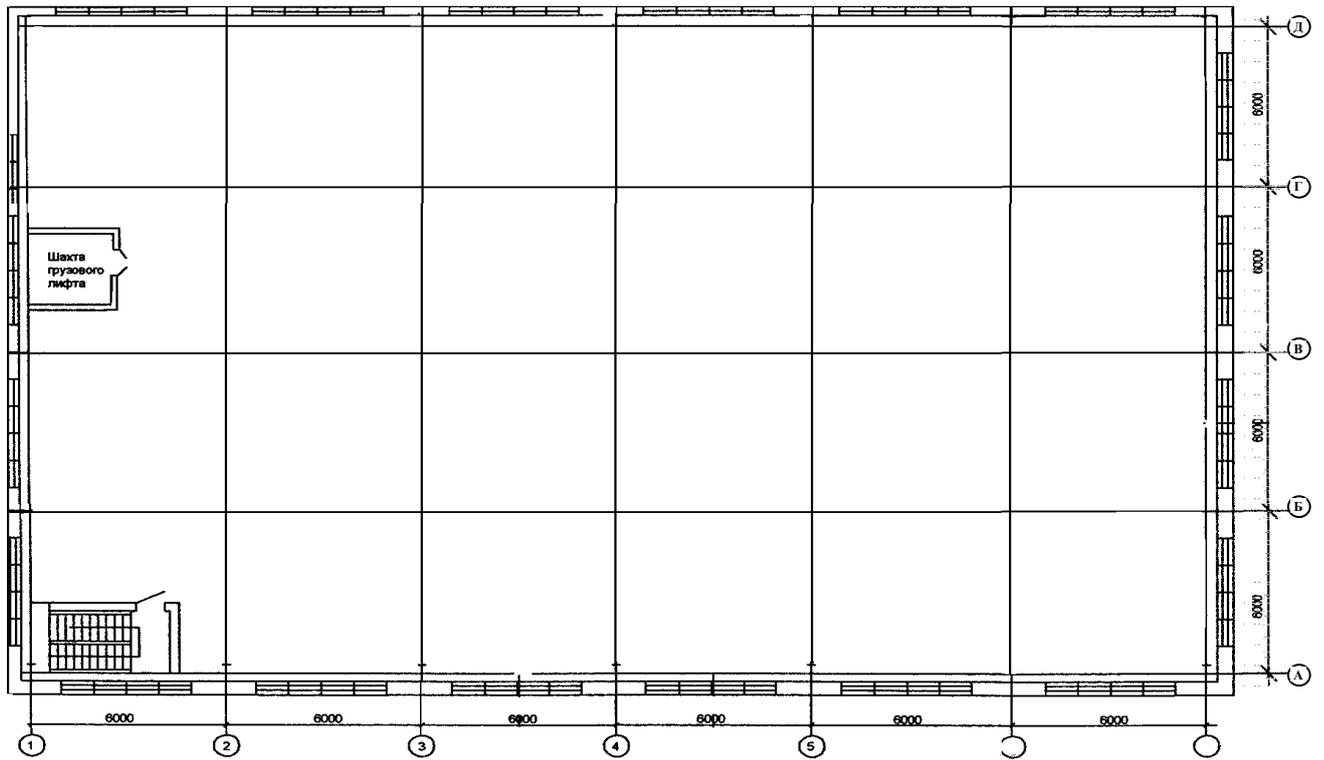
План здания размером 6х4 клеток (скопирован из папки "Шаблоны зданий")
